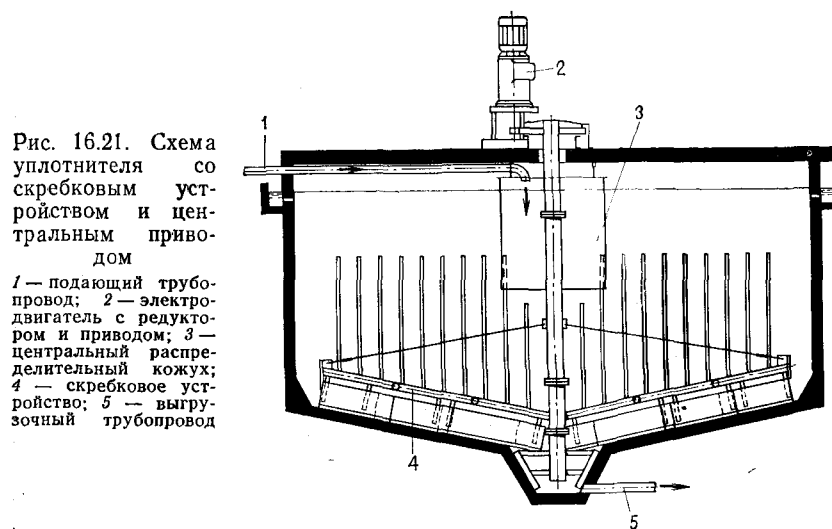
Схема уплотнителя со скребковым устройством и центральным приводом
